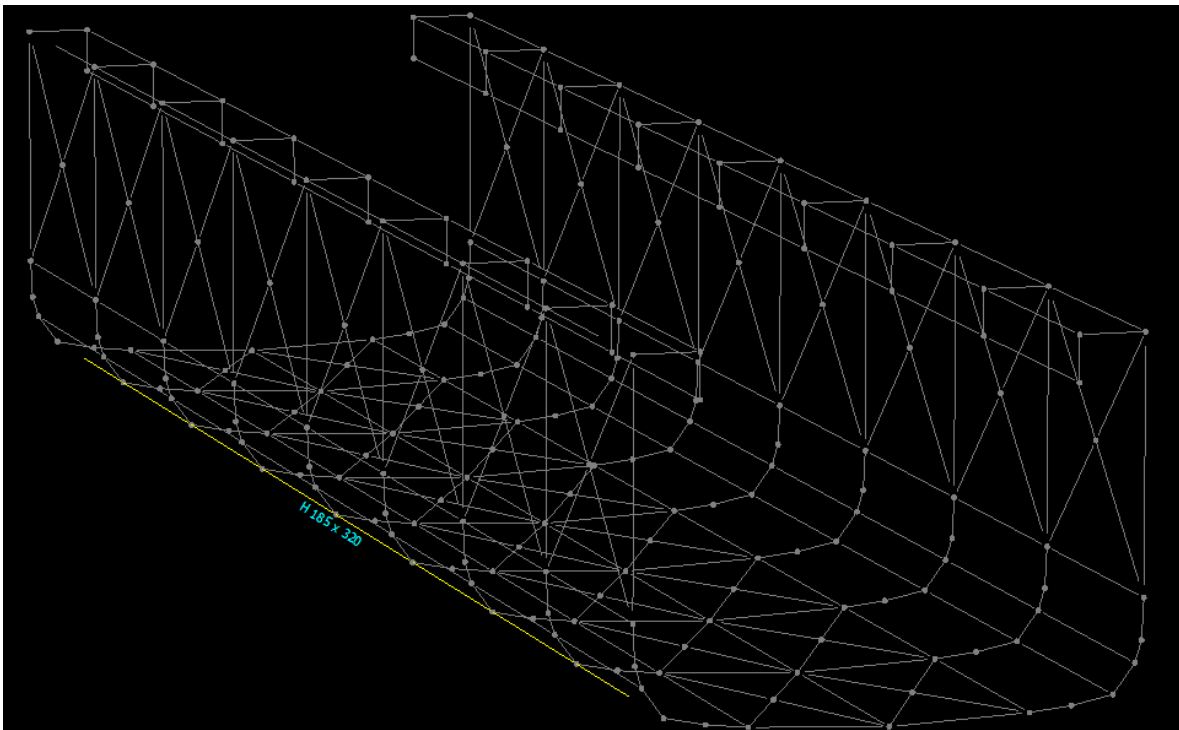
Reforzamiento longitudinal de anclajes de la estructura de protección.
